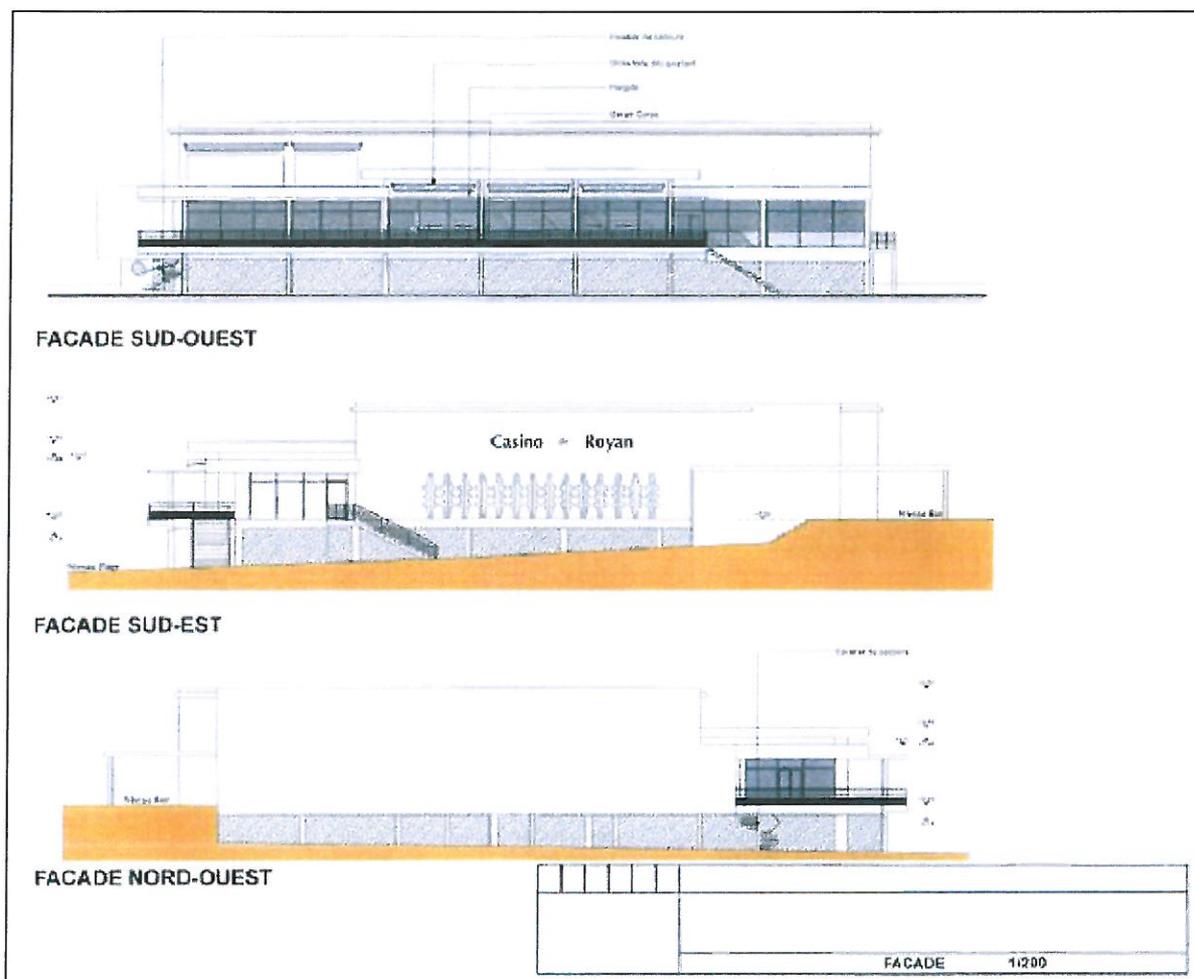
Plans des façades et des toitures du bâtiment associé au Casino de Pontailac.
